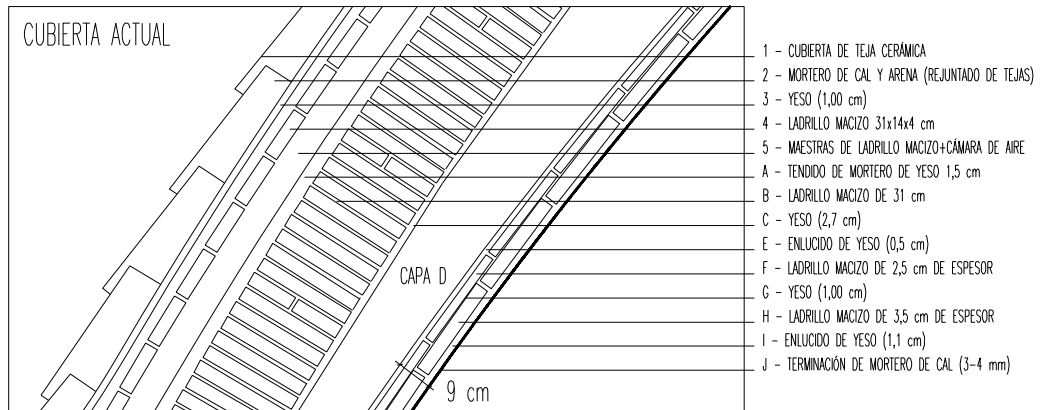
Sección constructiva de la cubierta existente antes de intervención.
